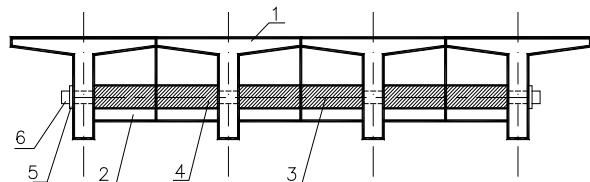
Поперечное обжатие напрягаемым арматурным элементом или пучком, закрепляемым после натяжения обетонировкой между стенками балок: 1 – балка; 2 – полуудиафрагма; 3 – арматурный стержень или пучок; 4 – бетонная рубашка; 5 – упорная шайба; 6 – анкер
